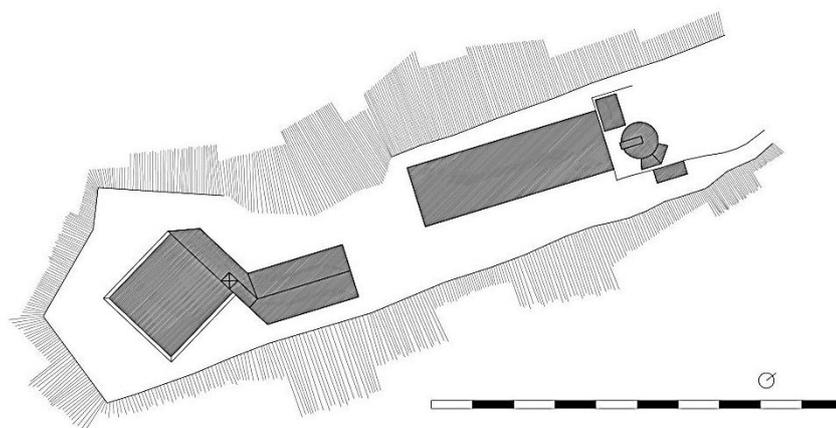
Observatorio Pic du Midi. Planta de conjunto.
